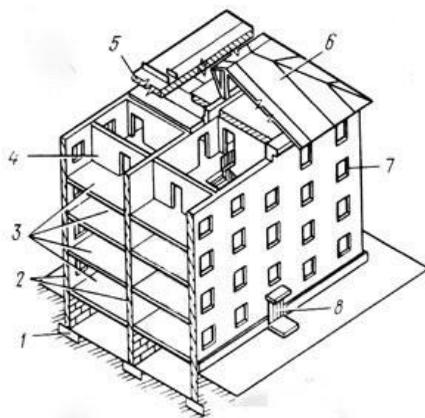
Основные конструктивные элементы зданий: 1 – фундамент; 2 – стены; 3 – перекрытия; 4 – перегородки; 5 – бесчердачная крыша (вариант); 6 – чердачная крыша; 7 – окно; 8 – дверь
